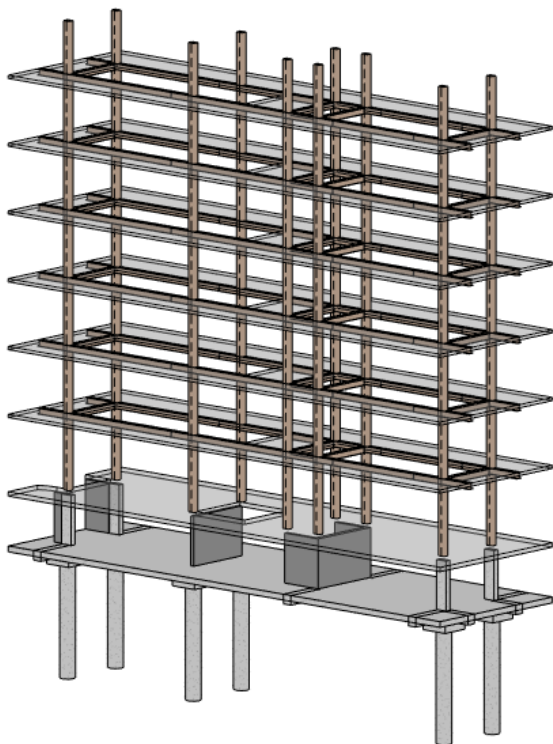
Visualização 3D do núcleo central em estrutura metálica, LOD200.
